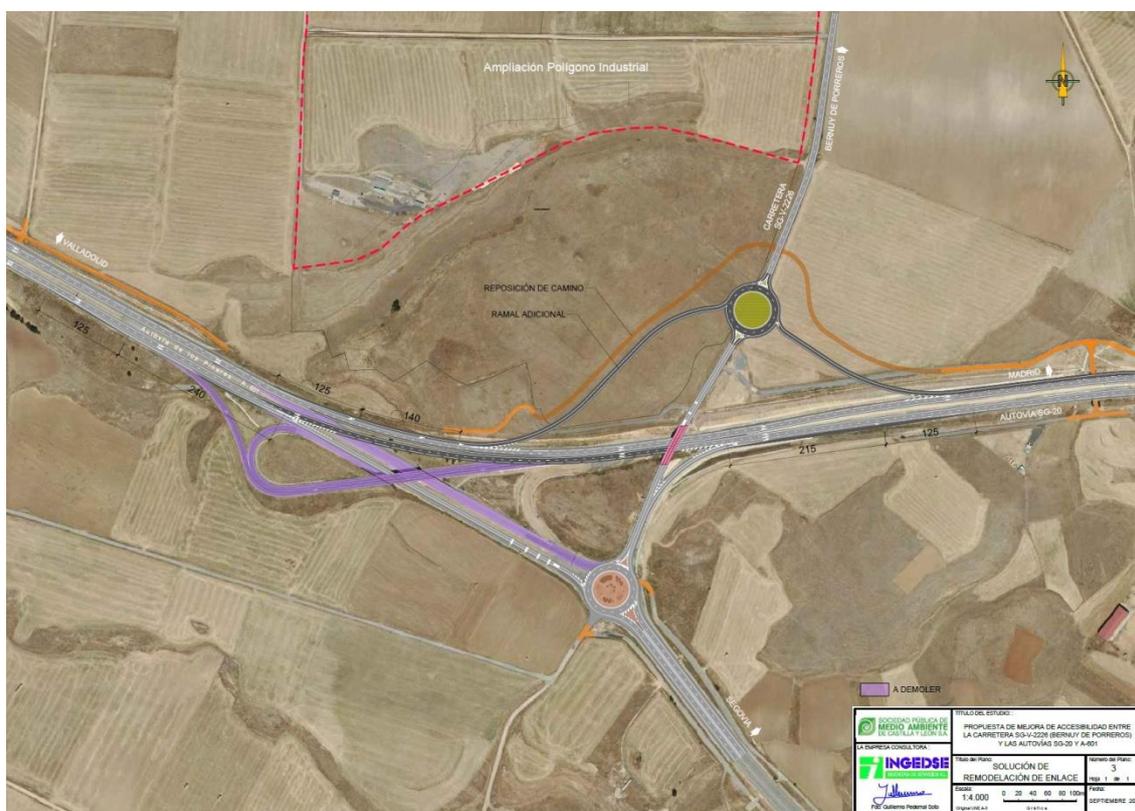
Propuesta preliminar de mejora de accesibilidad con las construcción de salida desde la SG-20, rotonda de conexión con la SG-V-2226, incorporación a la A-601, y supresión del paso elevado de conexión de la SG-20 sobre la A-601.
